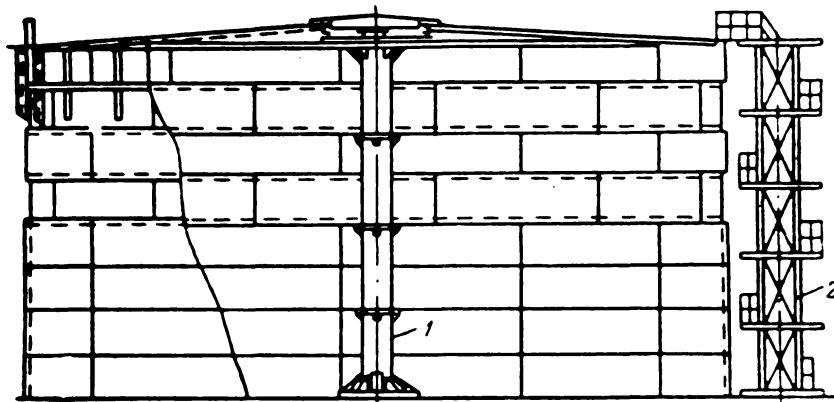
Вертикальный цилиндрический резервуар емкостью 5000 м^3 с центральной стойкой и щитовым покрытием
